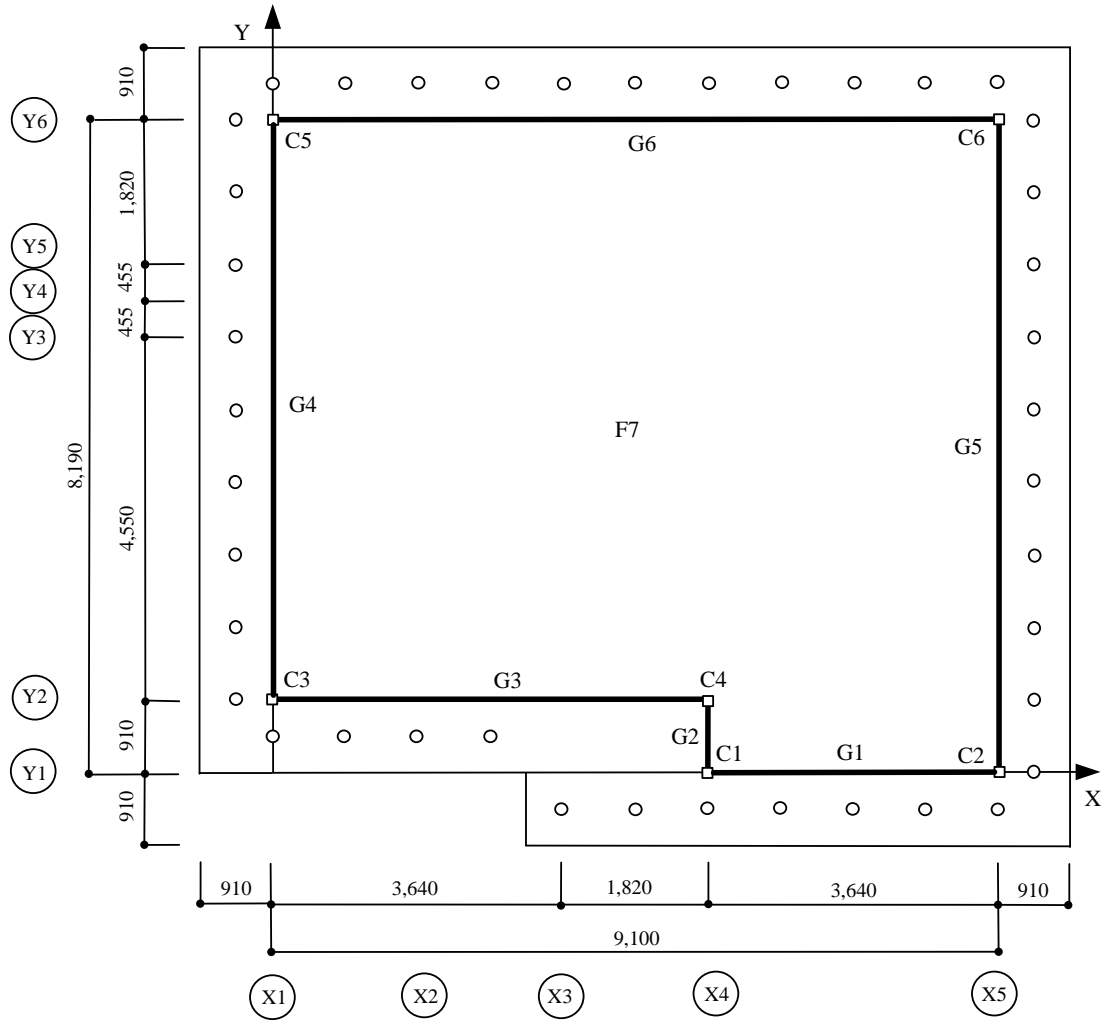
8 柱、全体フーチングおよび基礎梁の配置図
